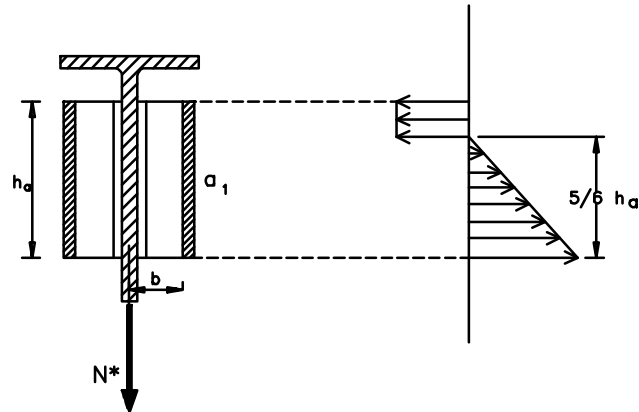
Soldadura de unión de los casquillos sobre el soporte.
